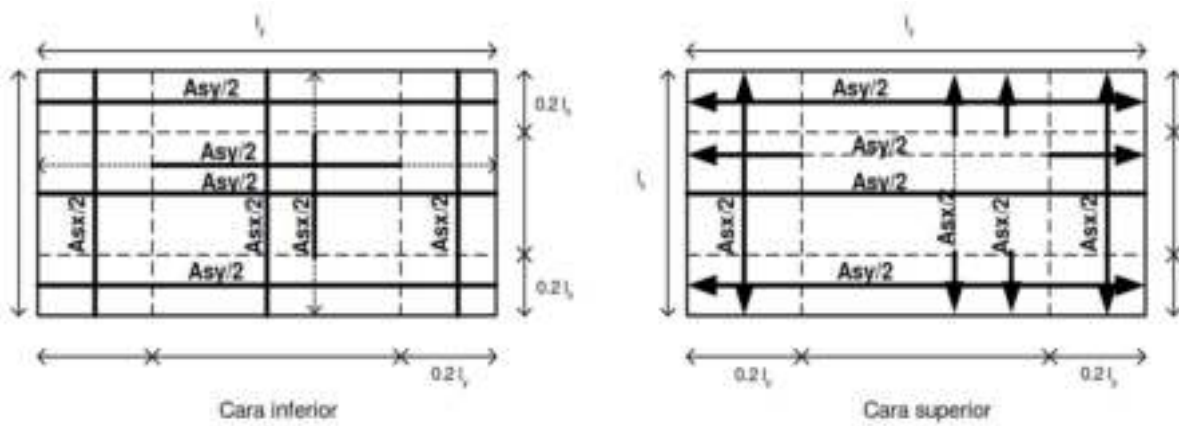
Disposición de armaduras en losas empotradas o continuas
